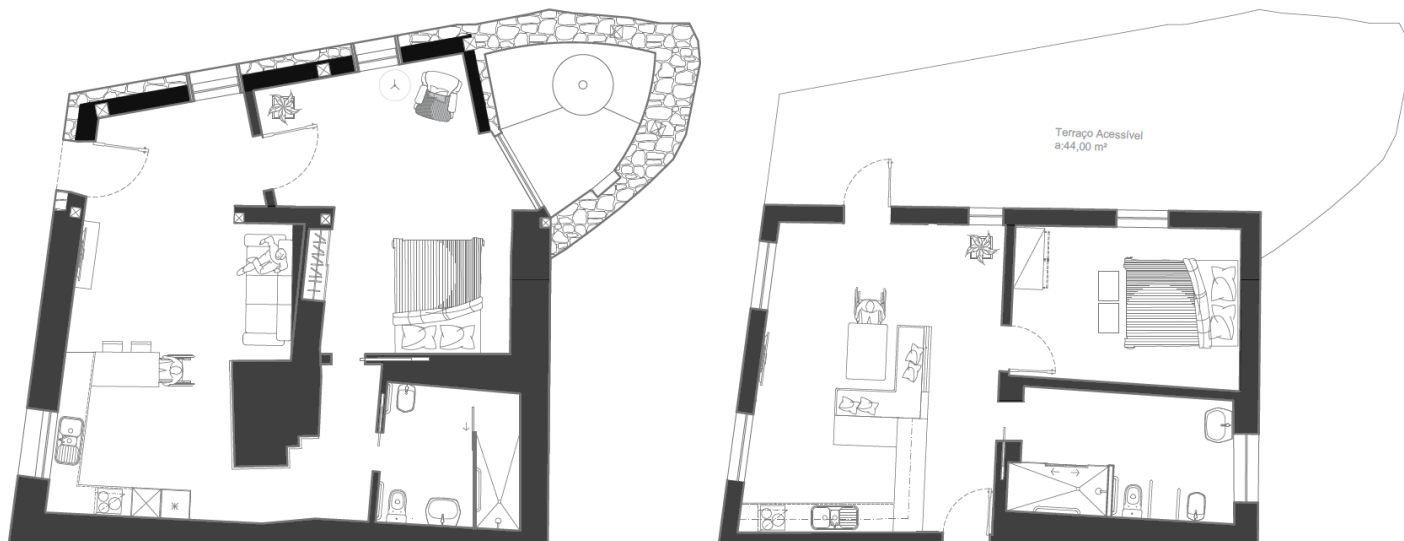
Casa 1: Planta do Proposto – planta da cave e r/ch respetivamente. Esboço 2
